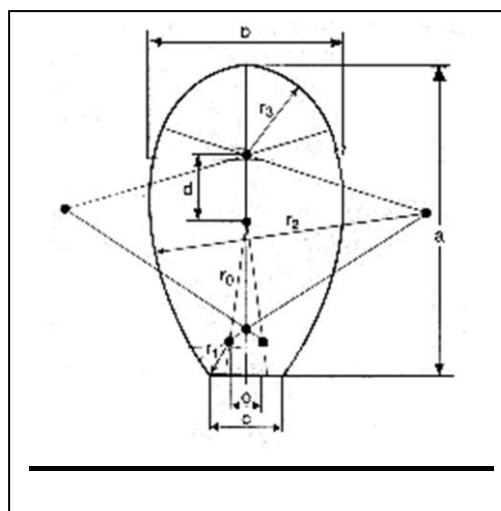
Coupe type d'un tuyau ovoïde préfabriqué
